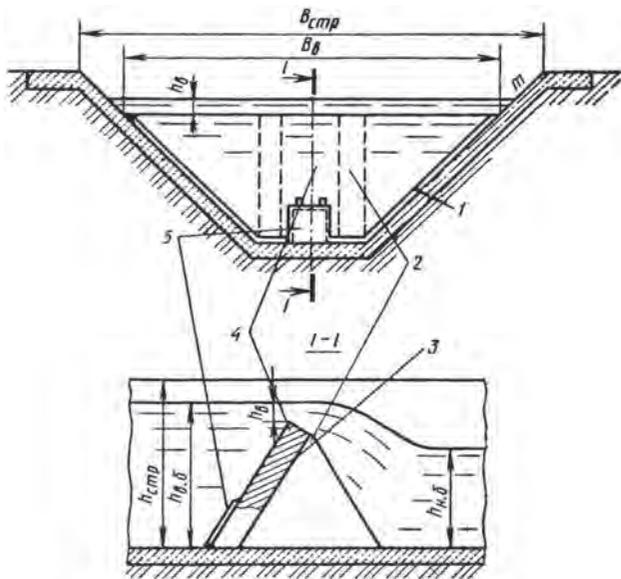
Схема стационарной перемычки на каналах-оросителях для ЭДМФ «Кубань-Л» на уклонах до 0,003: 1 – цементный раствор; 2 – упорный блок; 3 – закладные детали (сварка); 4 – блок-перемычка; 5 – затвор (заслонка) для очистки канала
